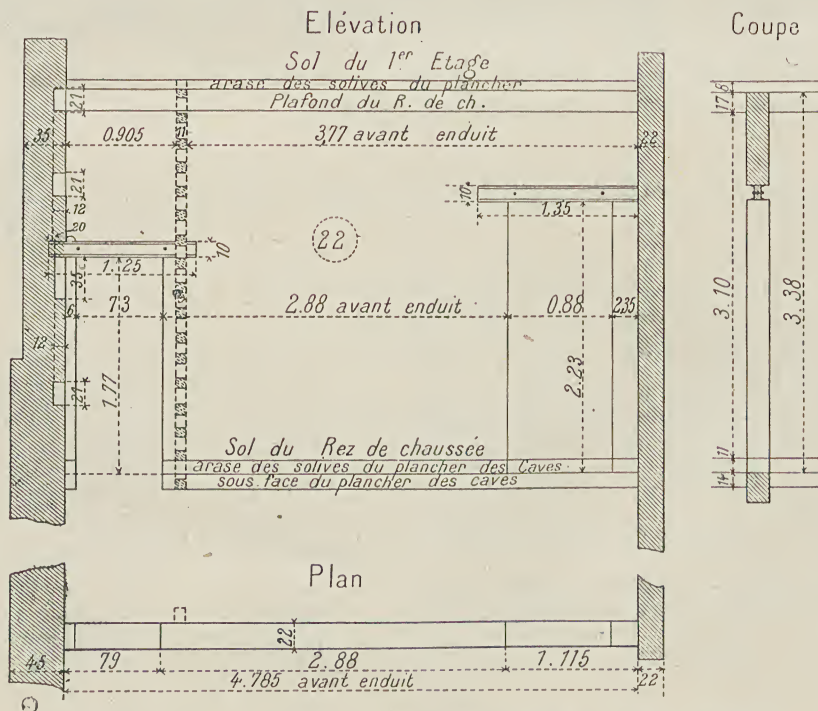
à 618. — Deuxième mur de refend parallèle à la façade principale.
